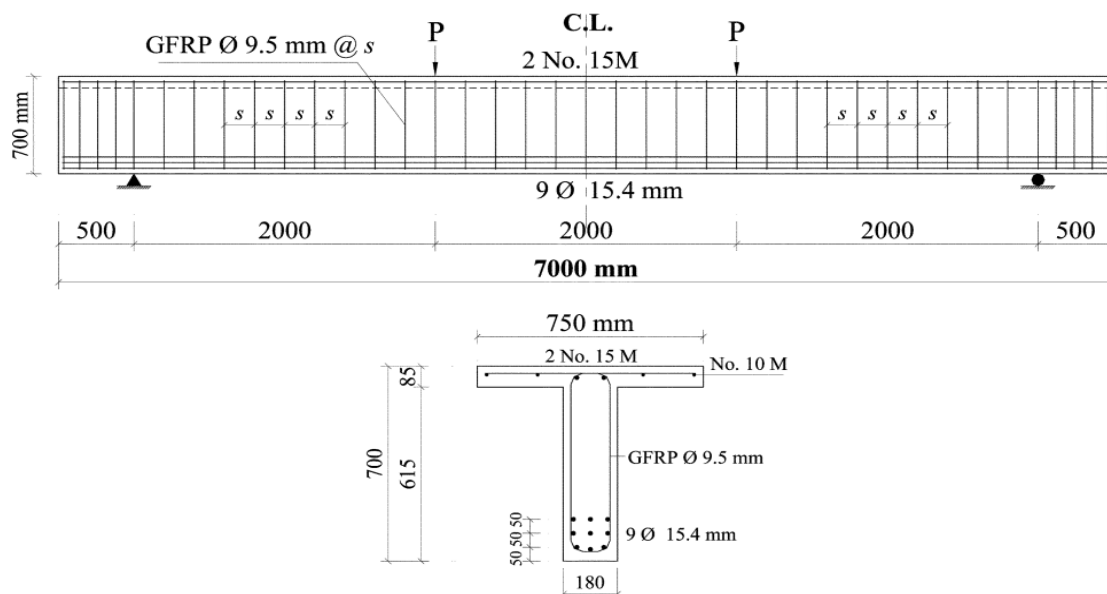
Pormenorização e sistema de ensaio das vigas ensaiadas por E. A. Ahmed et al [24]
